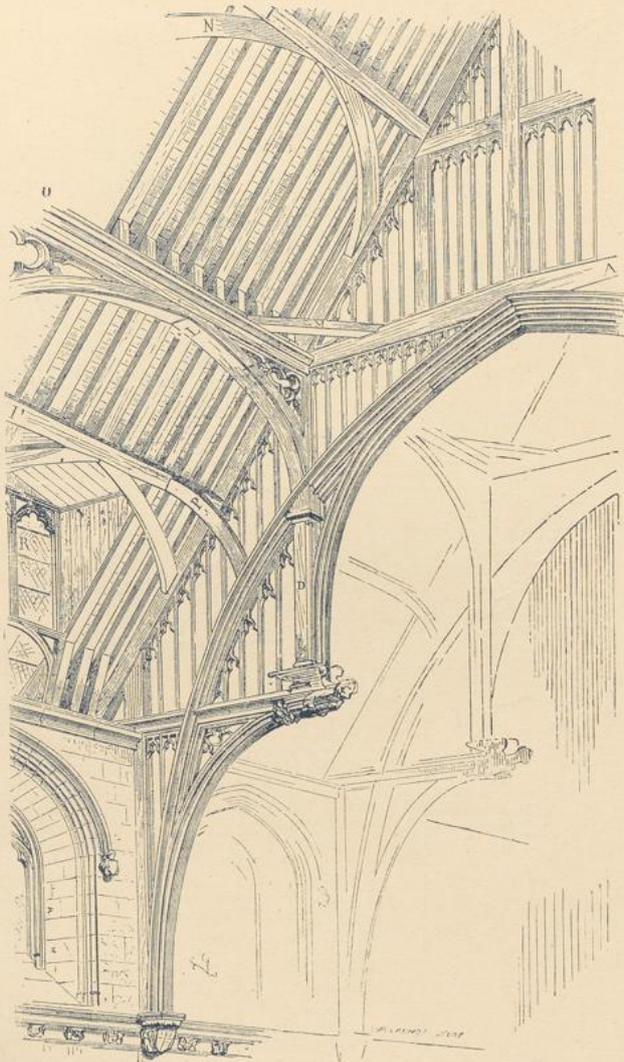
Dachstuhl der Westminster-Halle in London. Nach Viollet-le-Duc.
